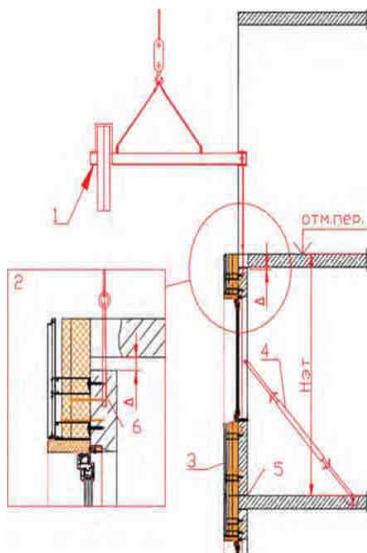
Схема установки фасадной панели: 1 – траверса с противовесом; 2 – беспетлевой монтаж панели; 3 – панель вентфасада; 4 – телескопический подкос для выверки панели; 5 – выверочные домкраты
